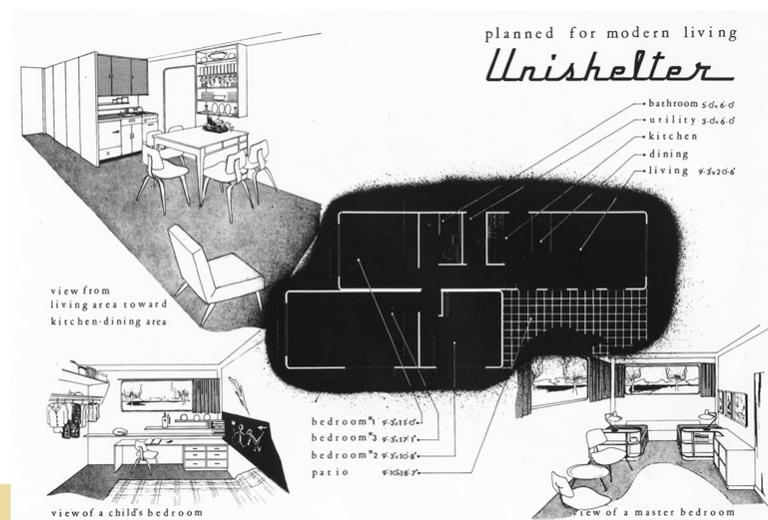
planimetria e viste interne della Unishelter house, Bertrand Goldberg, 1952 (sopra);
